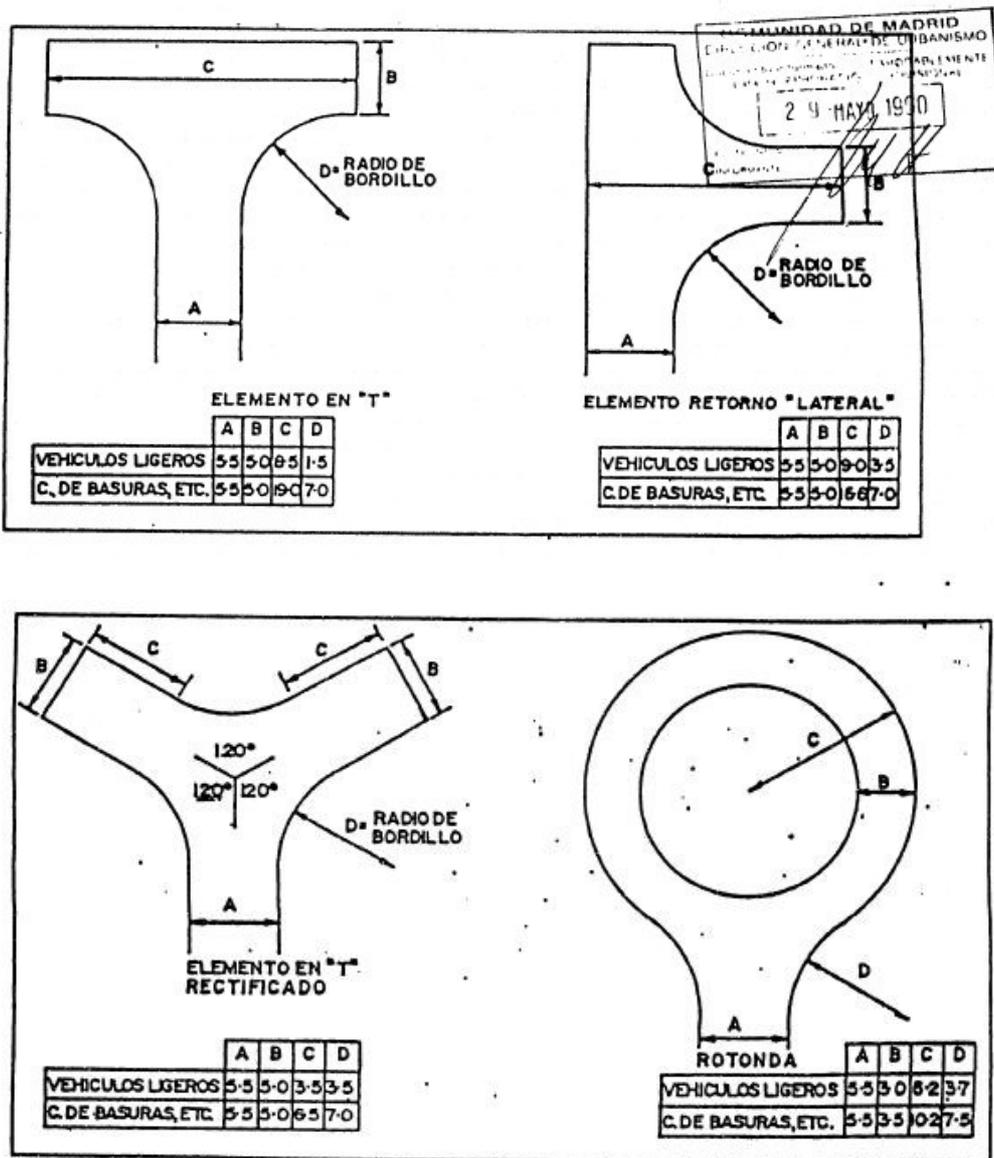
ELEMENTOS DE RETORNO EN VIAS EN FONDOS DE SACO.
